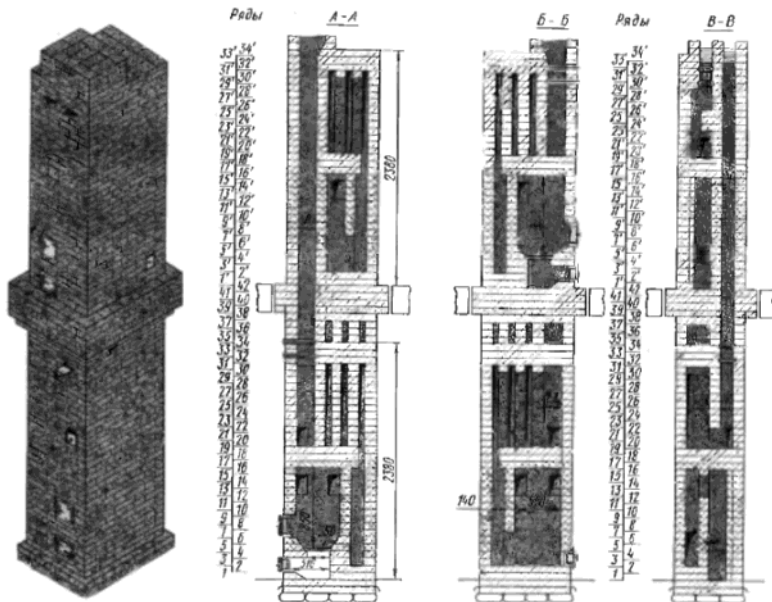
Топочная двухъярусная печь ПТД-4400/3500
